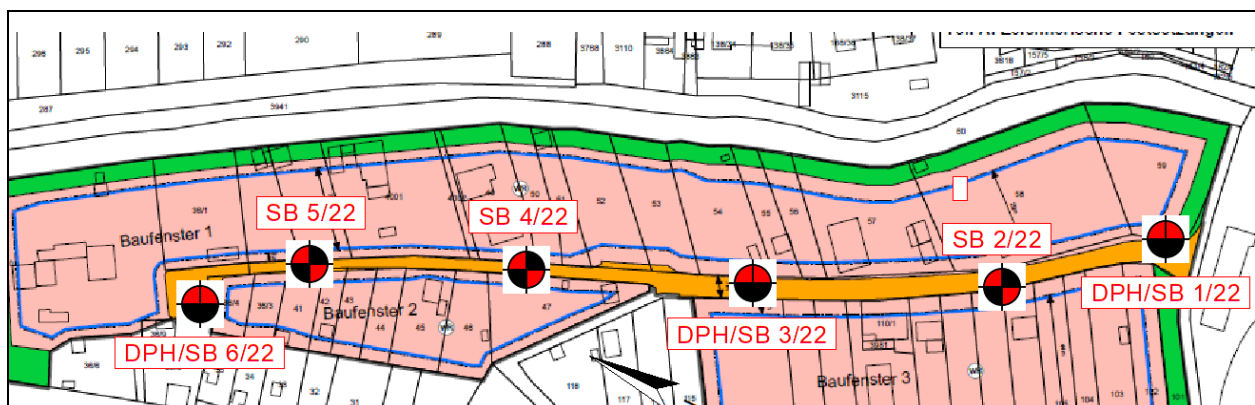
Übersichtslageplan, Aufschlussstandorte
